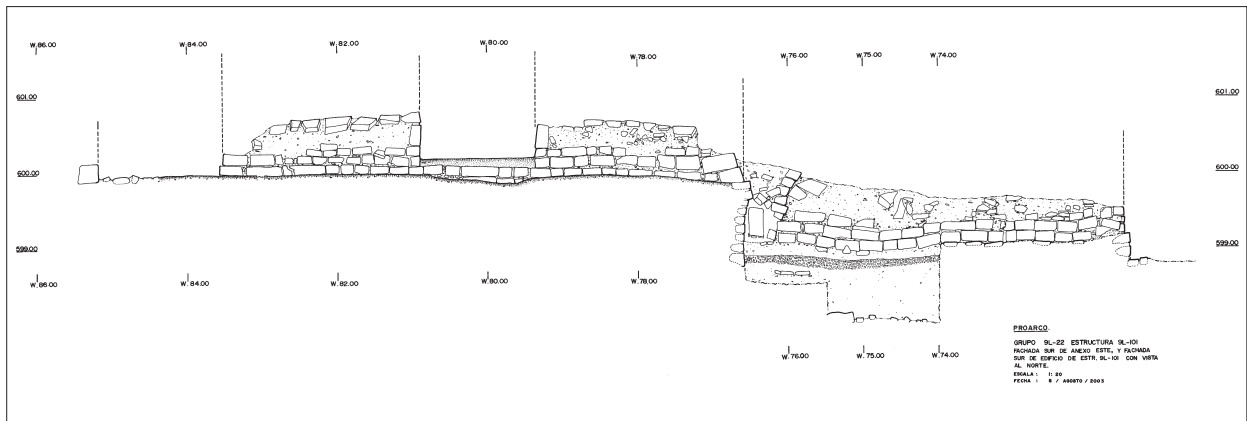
Fachada del edificio de 9L-101-1ª y anexo este, vista al norte
